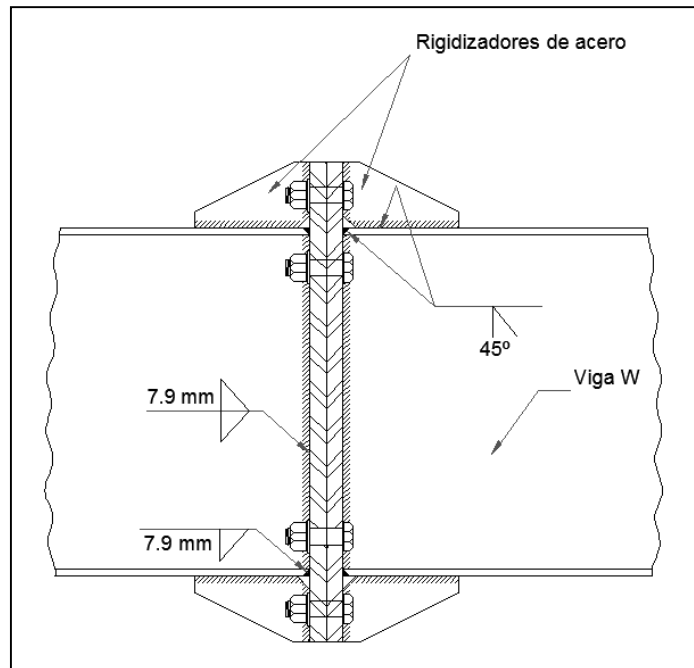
Ejemplo de soldaduras en una conexión de placa extendida rigidizada
